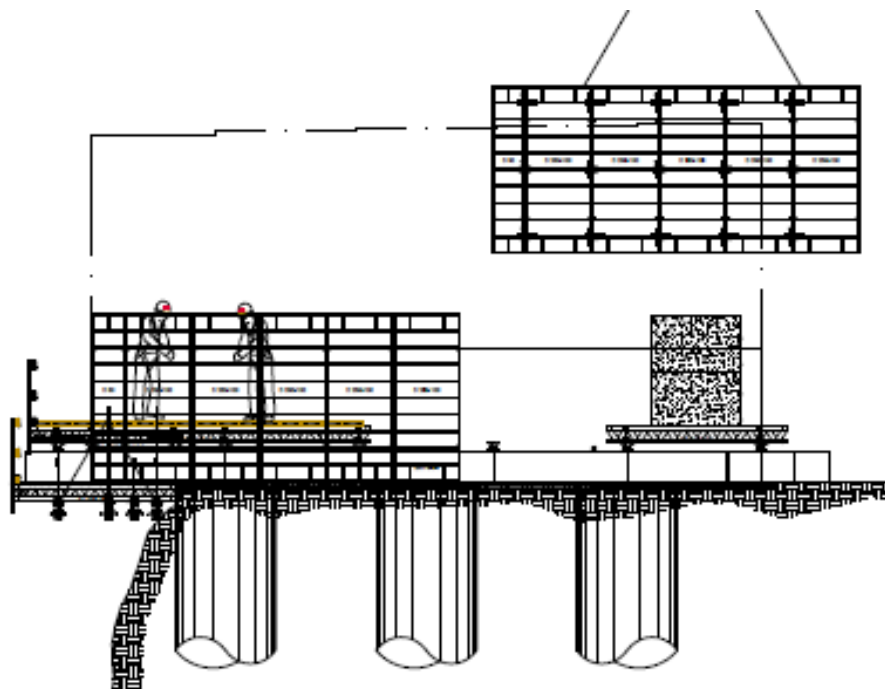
ENCOFRADO EN VOLADIZO – MONTAJE.
